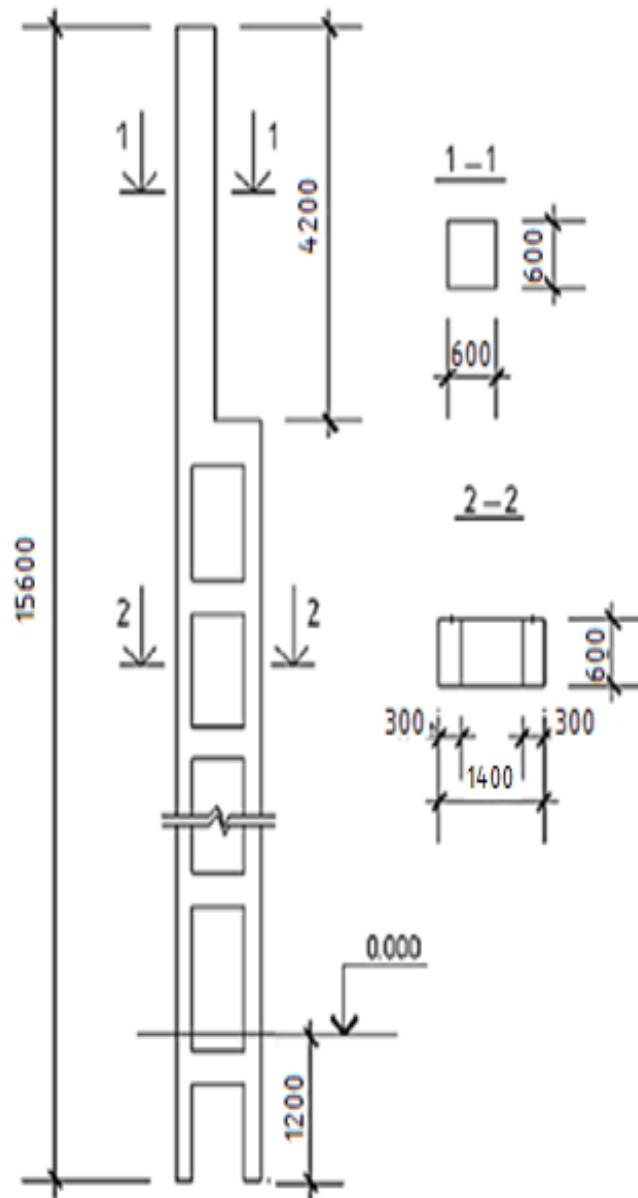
Залізобетонна колона крайніх рядів
